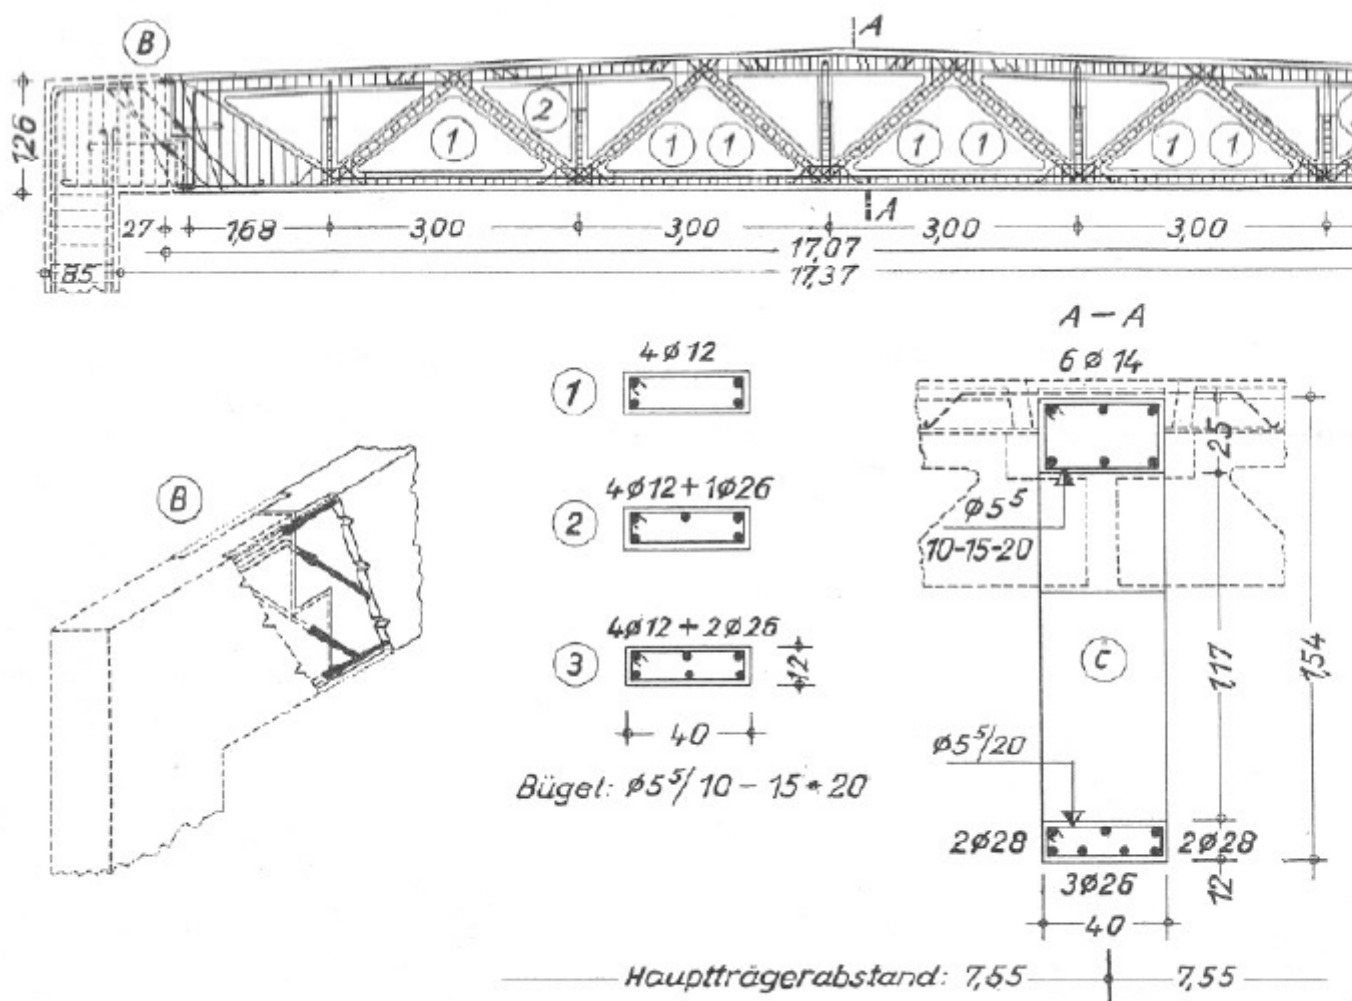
Hallenkonstruktion, Spannweite 17 m mit 9,5-t-Hauptfachwerkträgern. Biegesteif gefertigten Fachwerkriegels mit den Oribetonsäulen
